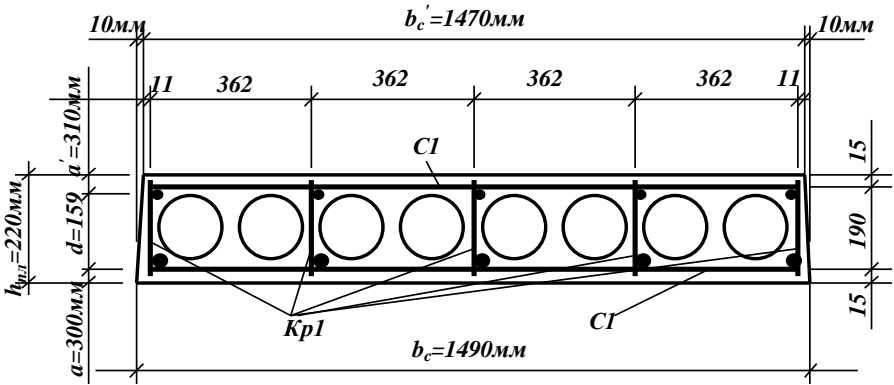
Опалубне креслення плити з круглими порожнинами
